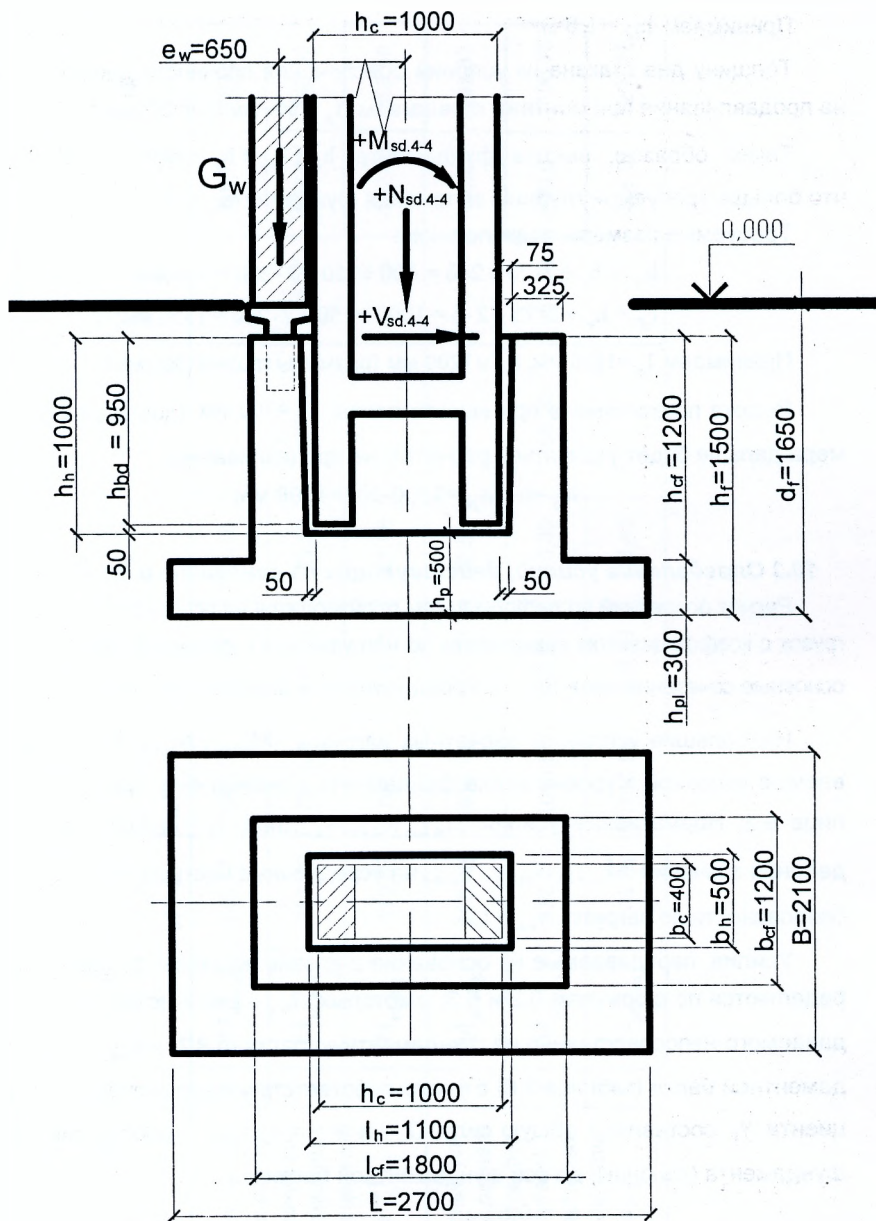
К определению размеров фундамента под крайнюю колонну
